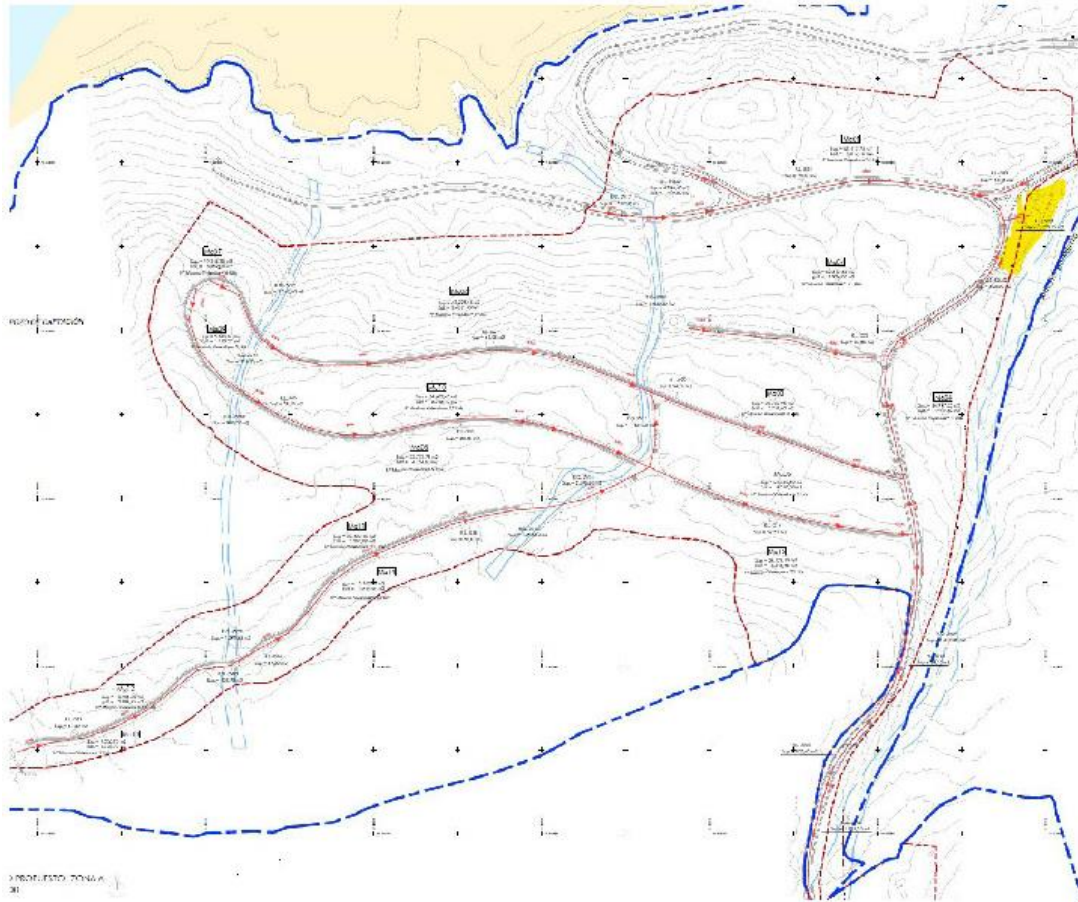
Red de saneamiento propuesta Zona A
